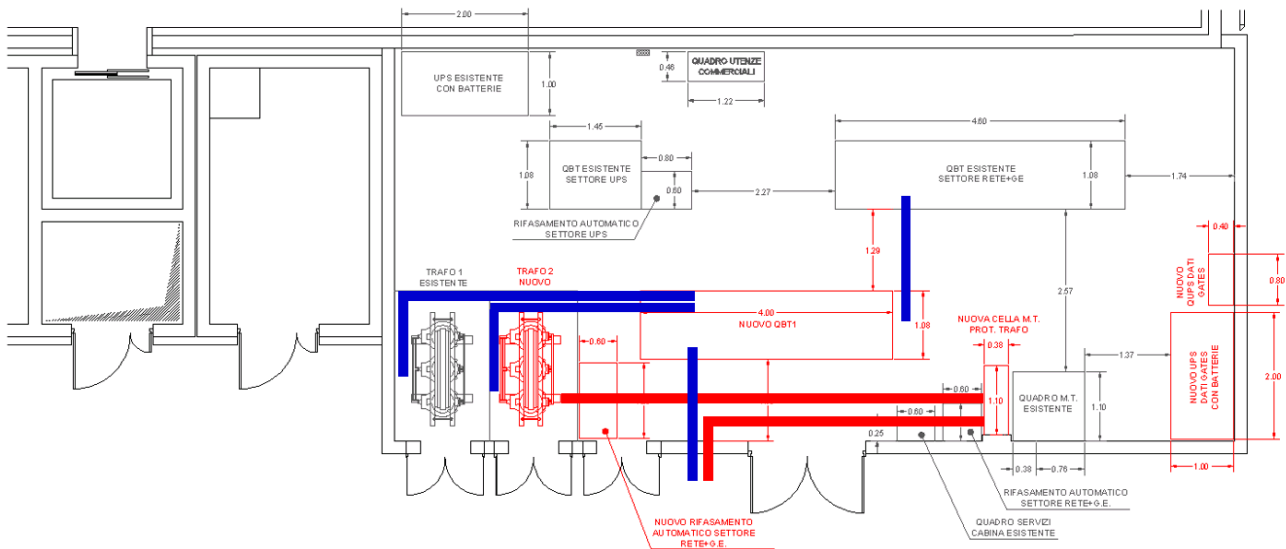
Layout (planimetria) della cabina MT/bt e disposizione degli apparati.
